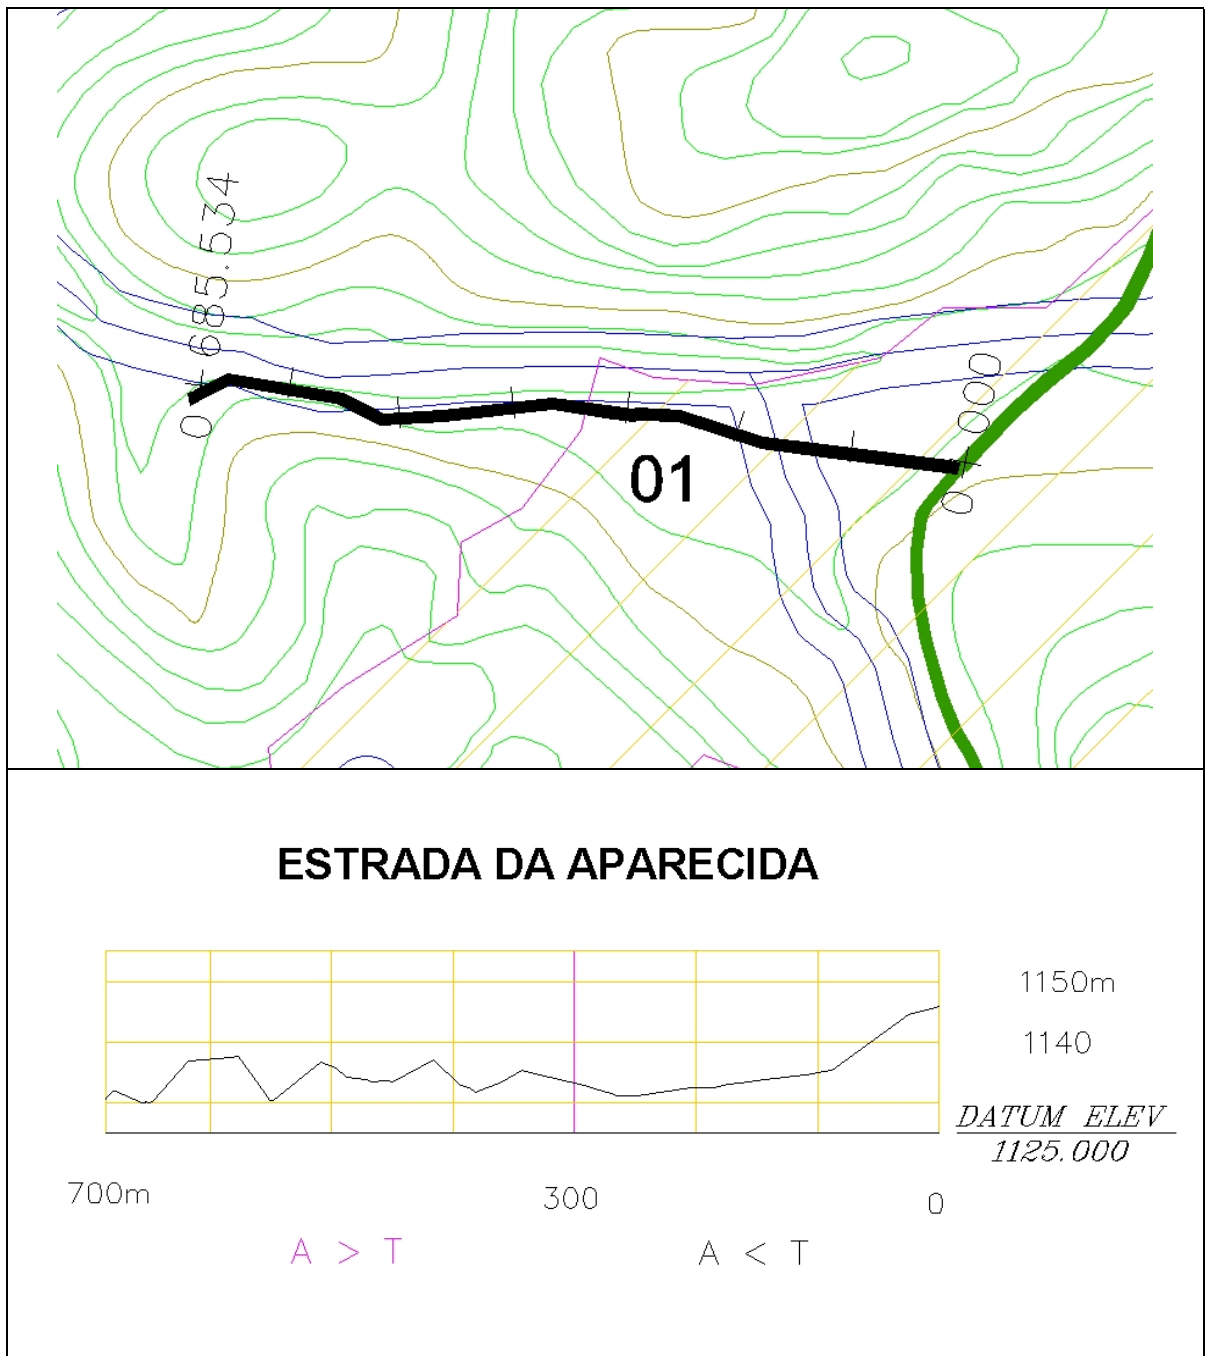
Planta e Perfil Topográfico da Estrada da Aparecida - 01 (MB1)
